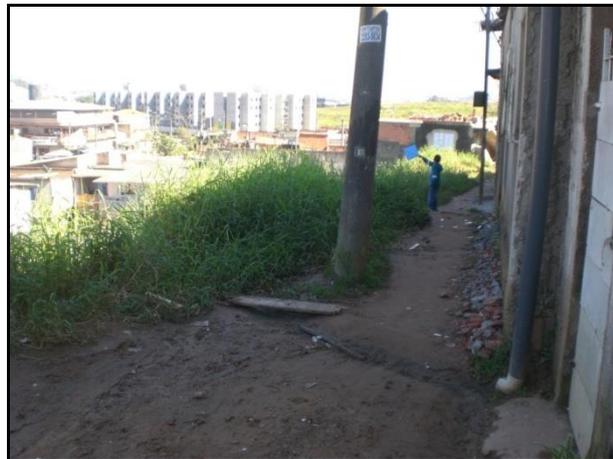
Trecho da Rua Gerber Wolfgang próximo à Travessa Formosa
